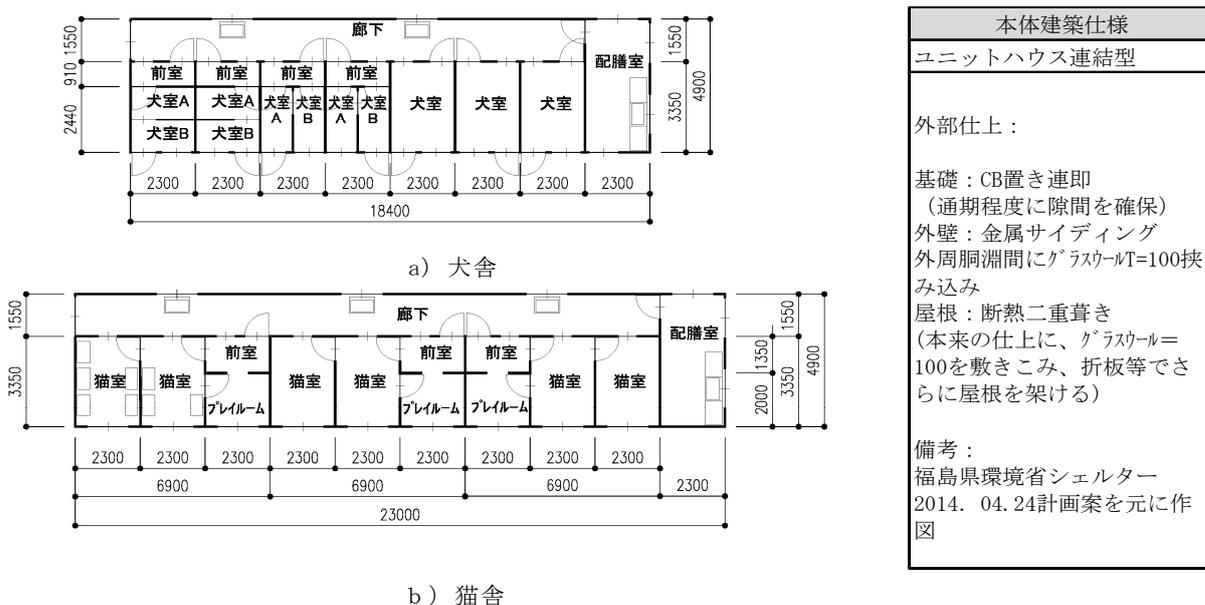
中長期収容型動物保護施設 動物舎平面図
